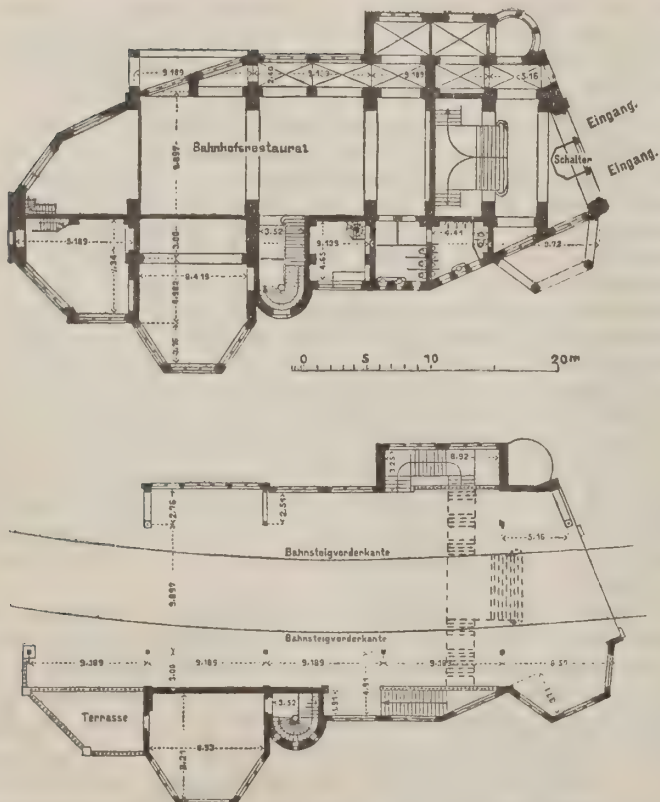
und 16. Grundrissanordnung des Bahnhofs
